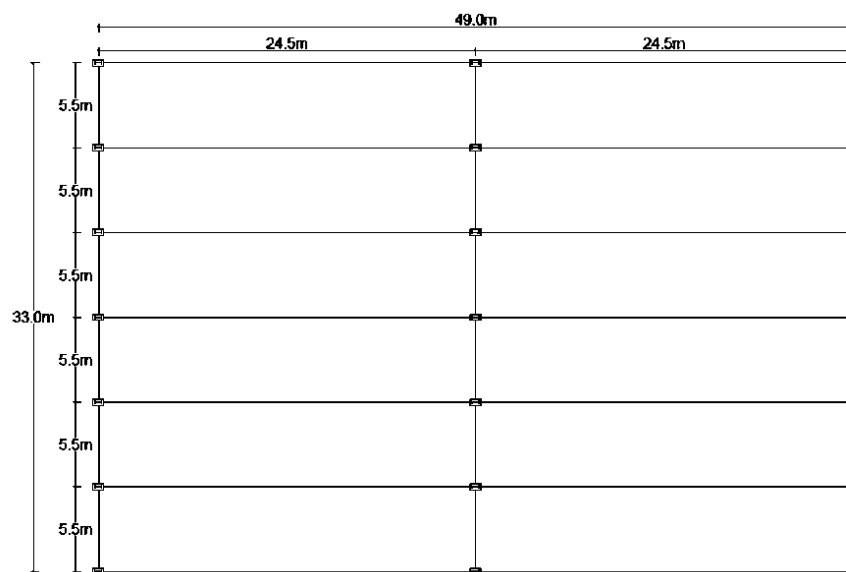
(f) Dimensiones de elementos de cimentación y cubierta vista en planta, (metros)
